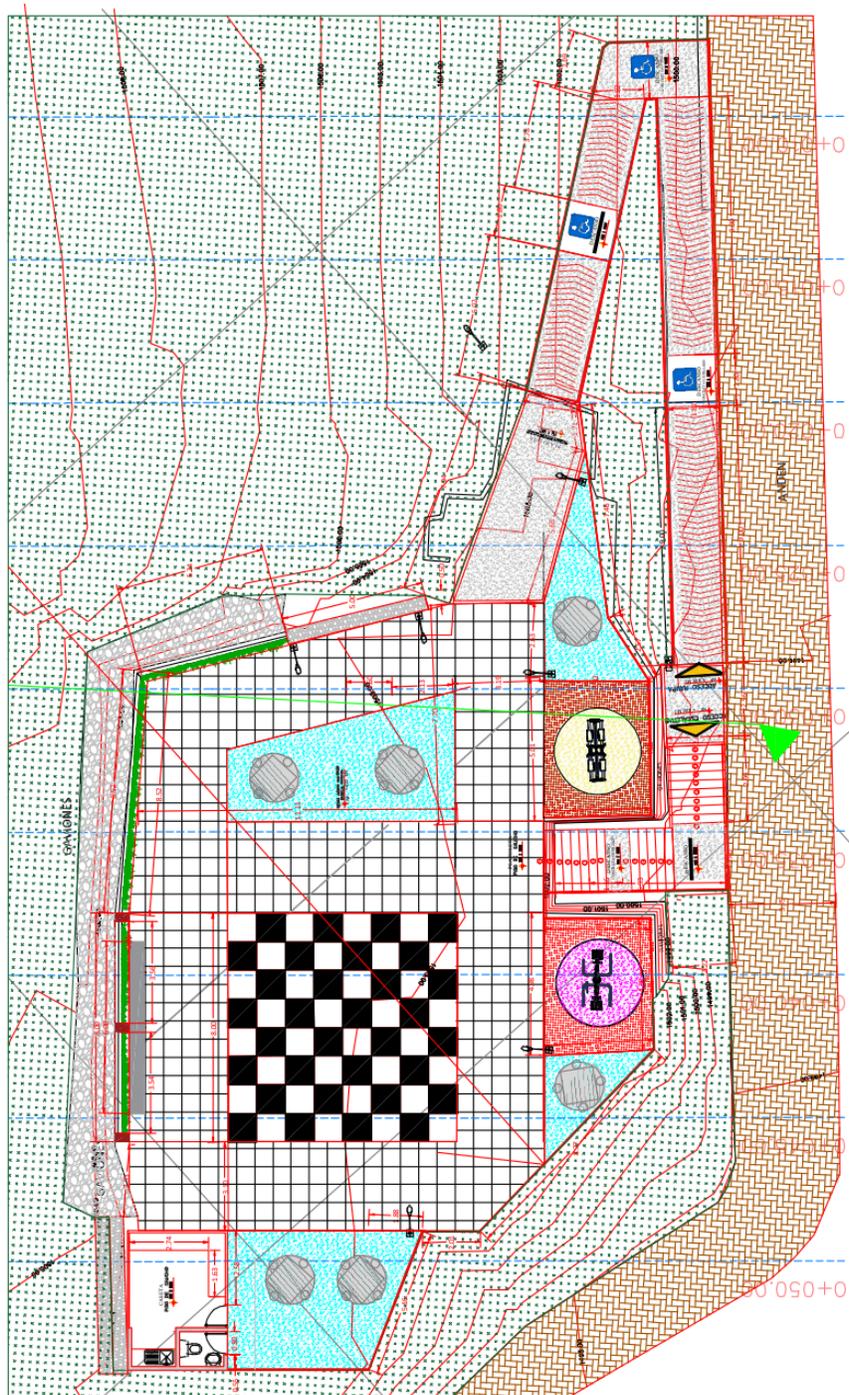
Planta arquitectónica parque Biosaludable Gramalote. Fuente: Guarín, E., 2021.
